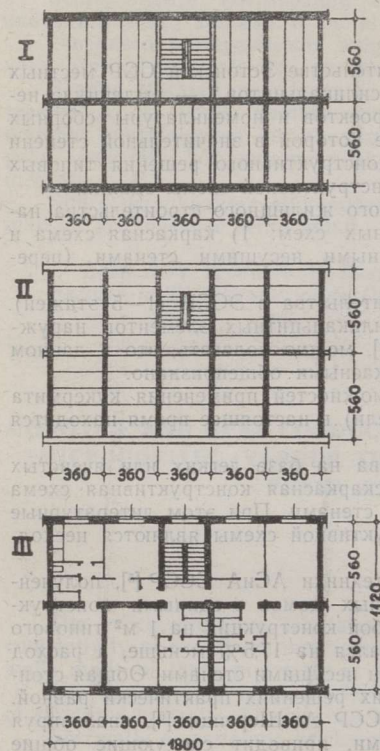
I — Конструктивная схема I. Панели перекрытия опираются на наружные и внутренние продольные стены.
